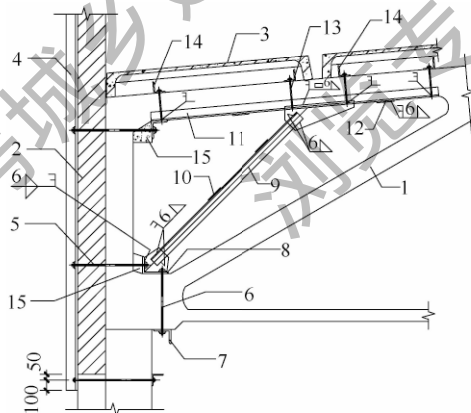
钢筋混凝土梯形屋架上弦第一节间修复加固做法
